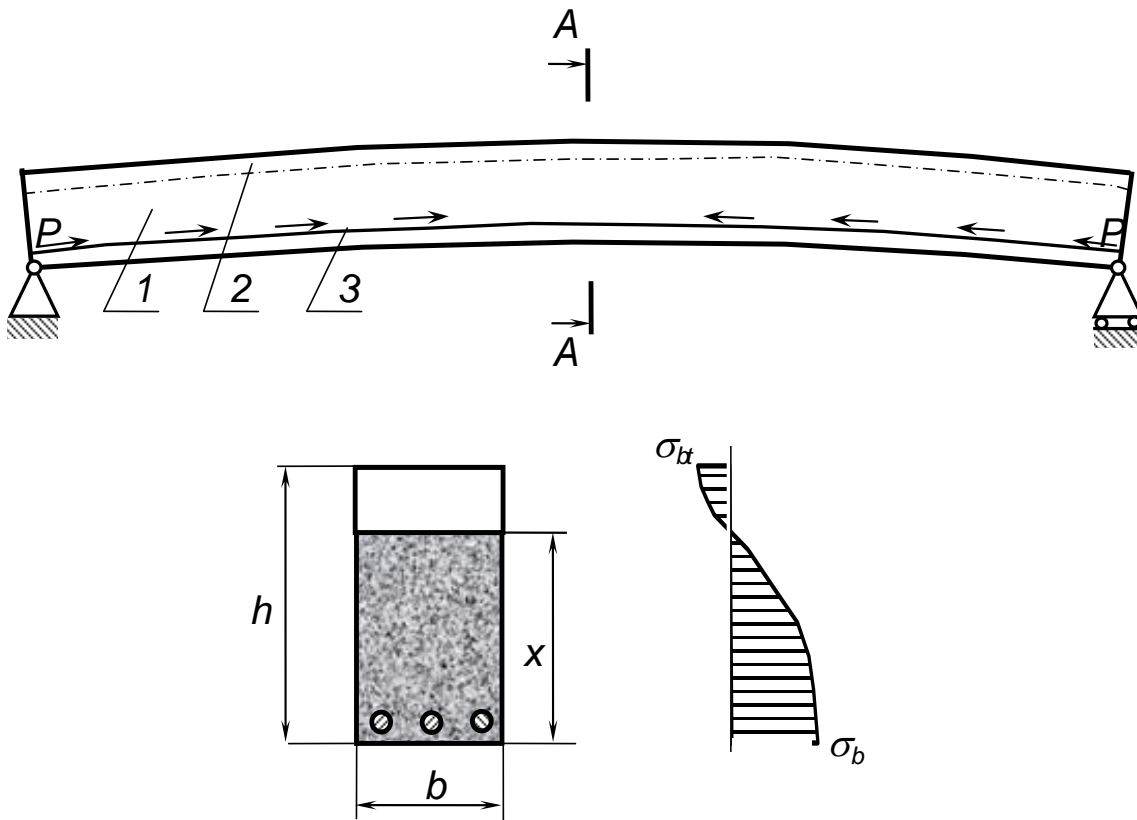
Схема попередньо напруженої залізобетонної балки: 1 – стиснута зона; 2 – розтягнута зона; 3 – попередньо напружена арматура P – зусилля попереднього натягу
